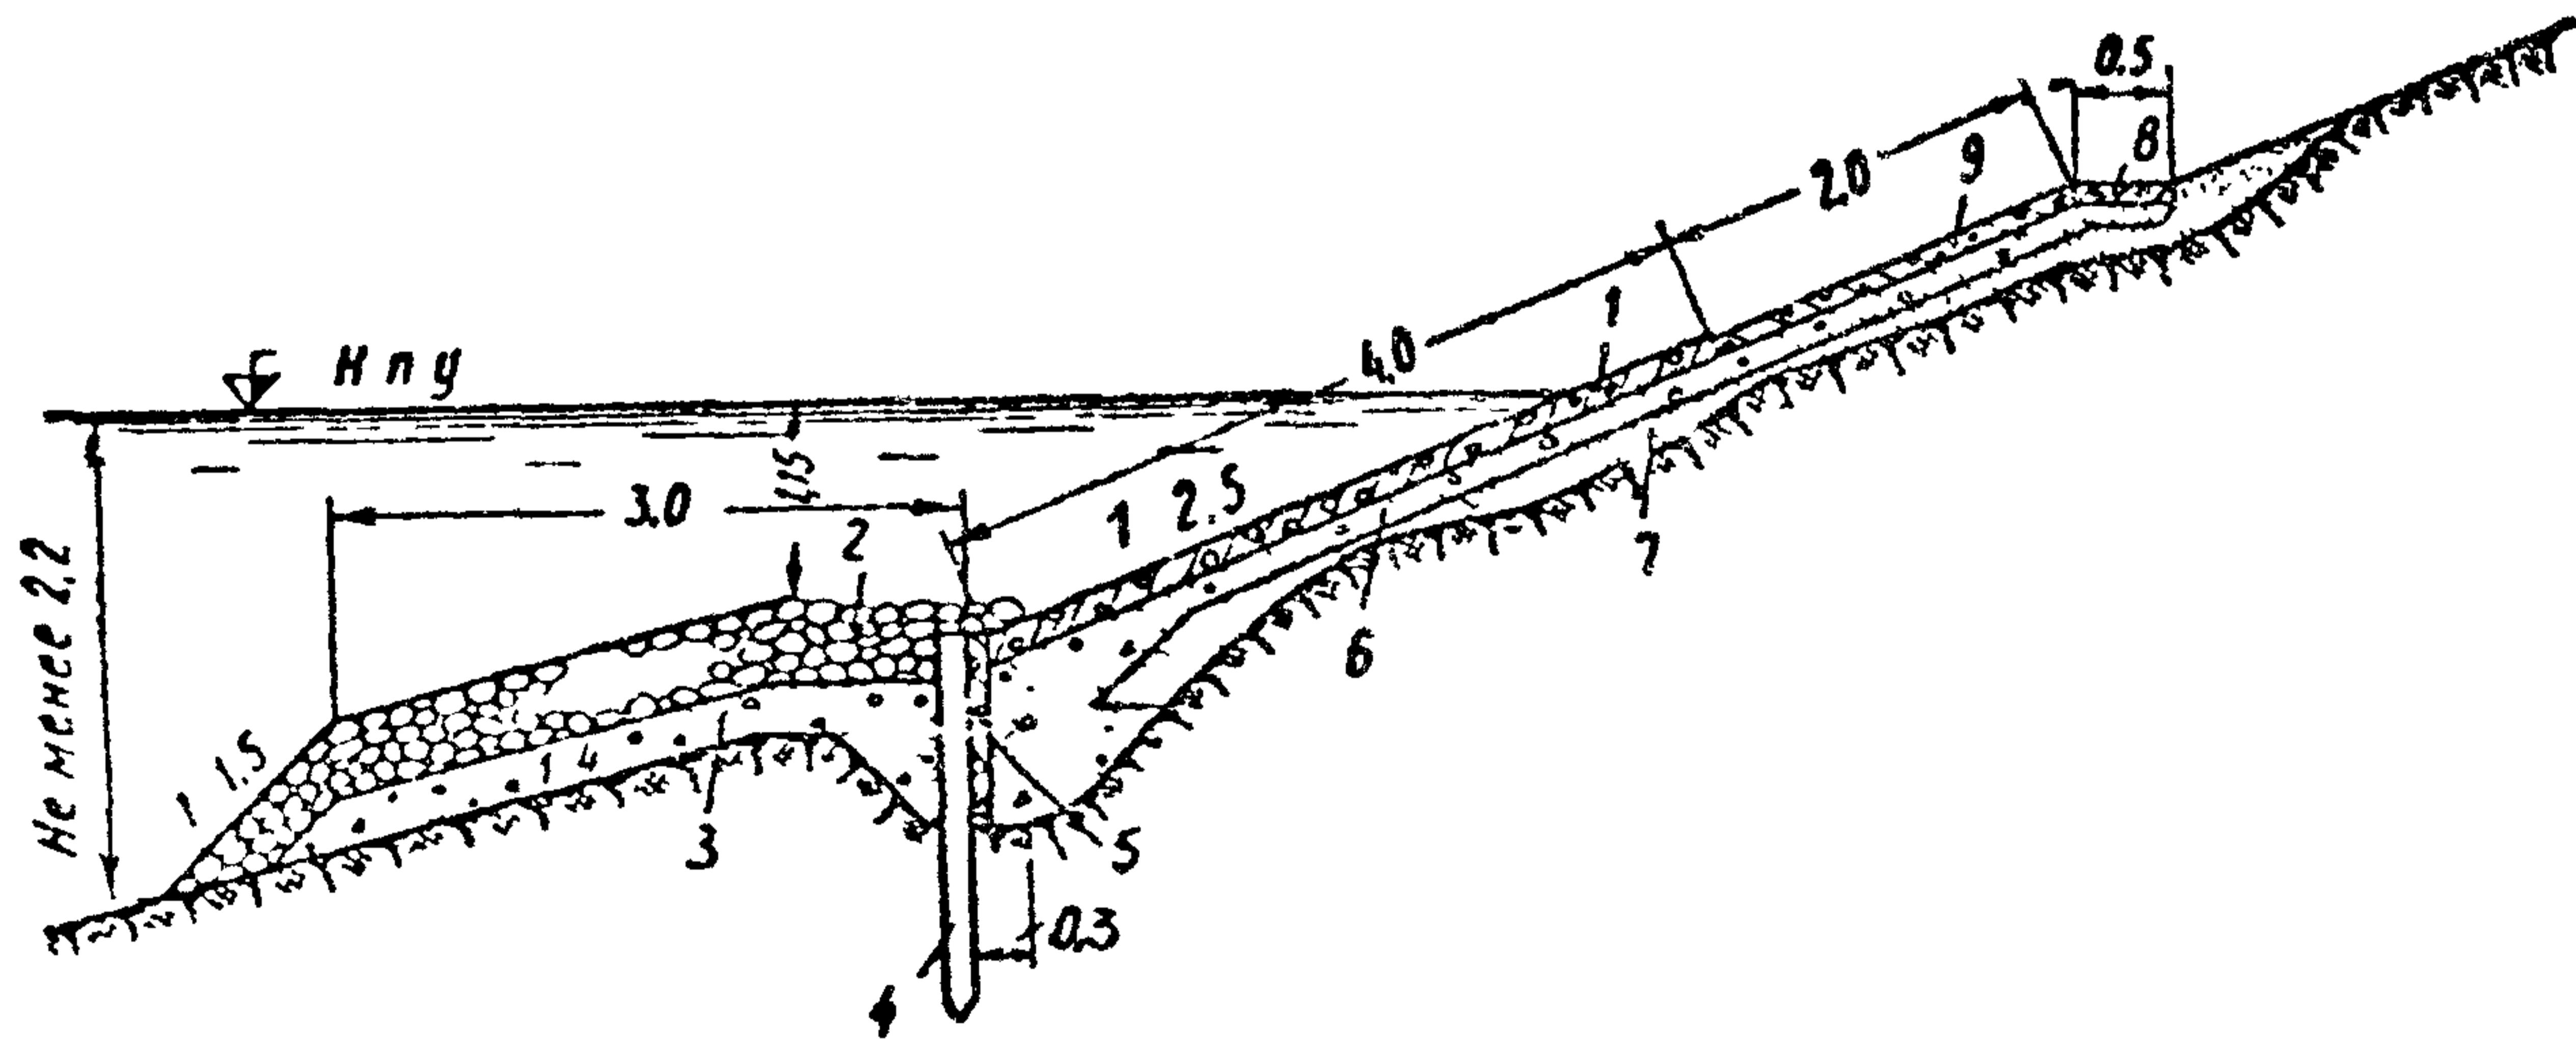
Поперечный разрез крепления откоса сборными железобетонными плитами, смоноличенными по контуру, на канале имени Москвы:
